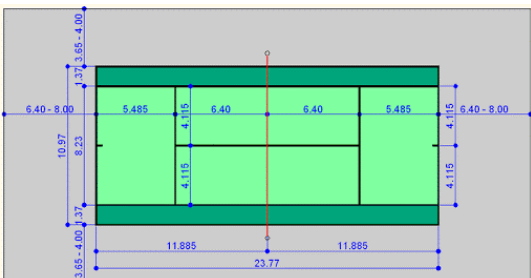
Dimensiones de la cancha de tenis. (Tenistas, 2020)
